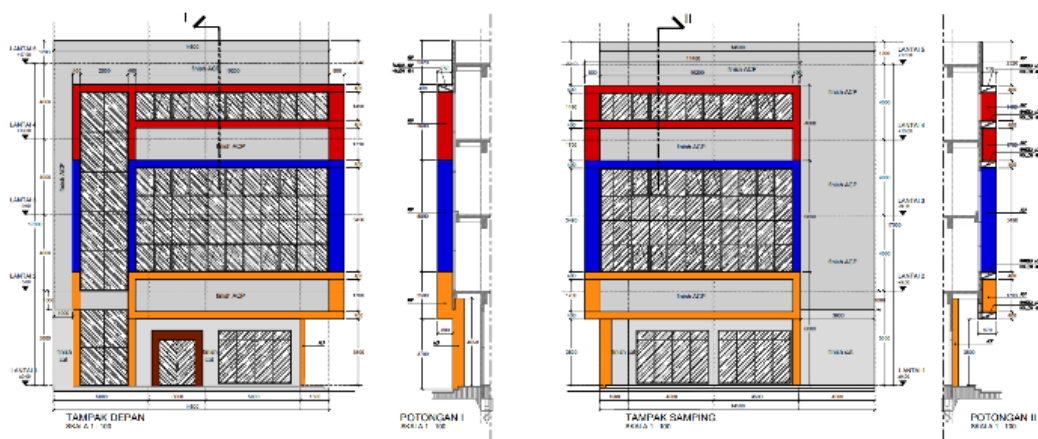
hingga Gambar 5 menunjukkan denah, tampak depan, tampak samping, serta detail kolom dan balok dari struktur gedung yang telah disiapkan.
